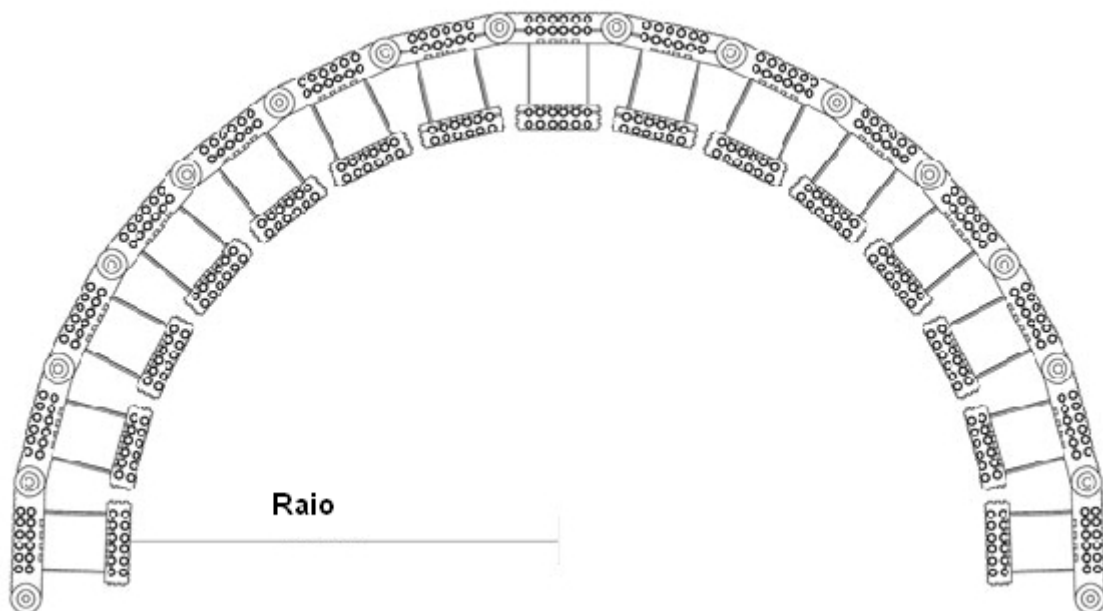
Planta de uma parede redonda com elementos para paredes redondas com dobradiças (adaptado de ARGISOL, 2010).
